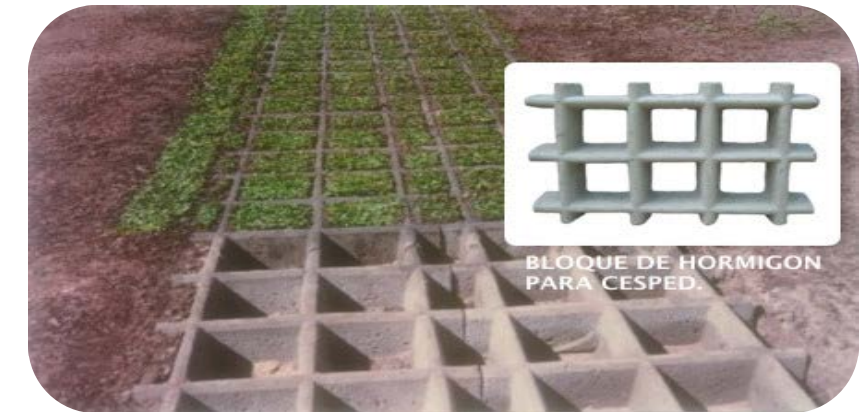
Fotografía extraída de presentación: Barrio 20 minutos. Plan de Portland. 2012
